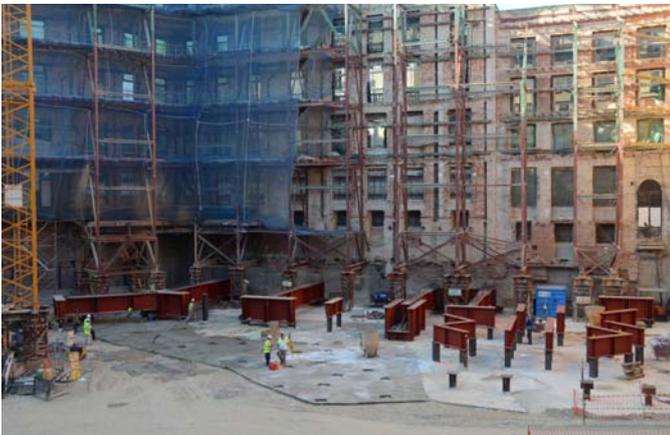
Vista general de los primeros encepados provisionales asociados a la planta interfaz
